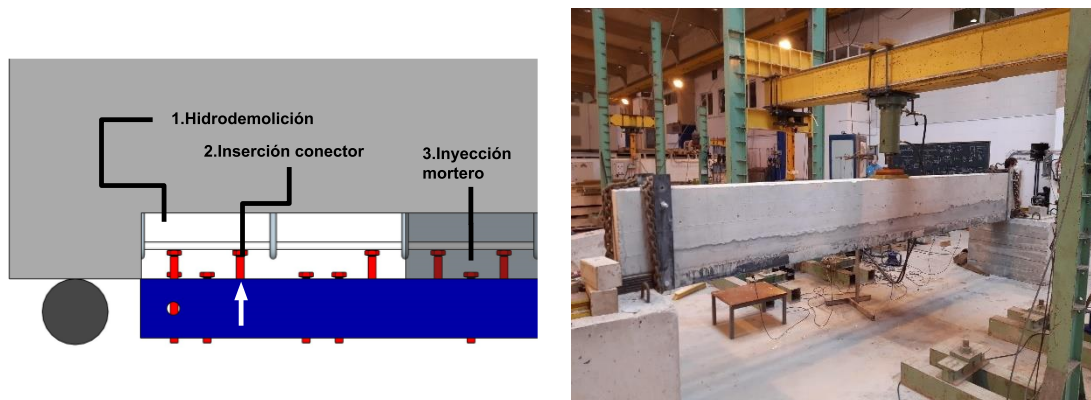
(a) Vista de la secuencia constructiva (b) viga dispuesta en laboratorio para ensayo a carga centrada.
